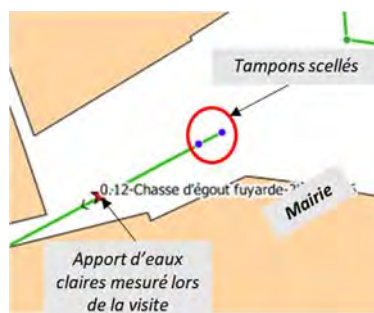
localisation défaut sur chasse d'égout - Visite de Nuit - Système Zibac
